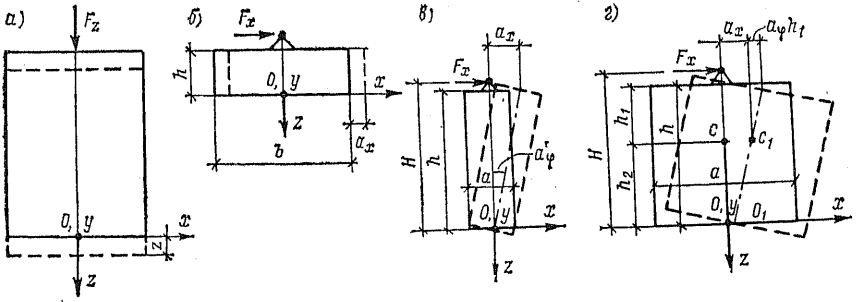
Схемы к расчету вынужденных колебаний фундамента
